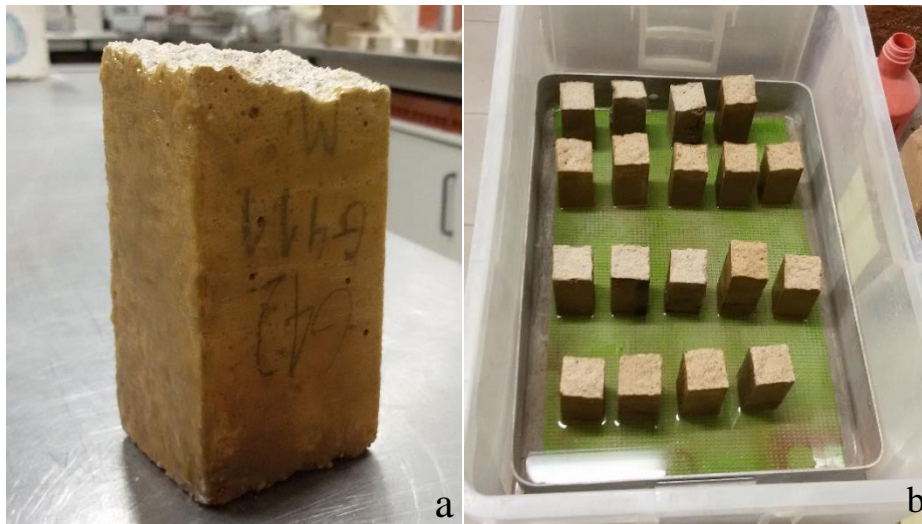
Provete envolto em mistura impermeabilizante (a) e ensaio de capilaridade (b)
